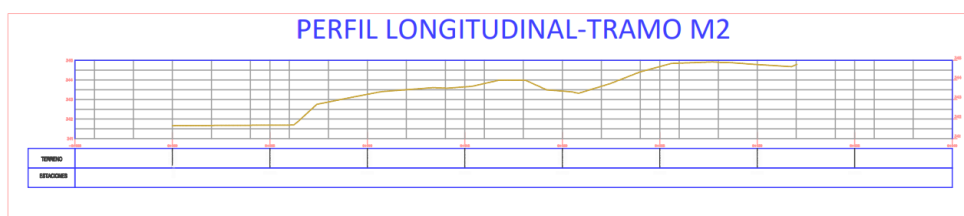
Perfil longitudinal de la zona en estudio del M - 2
